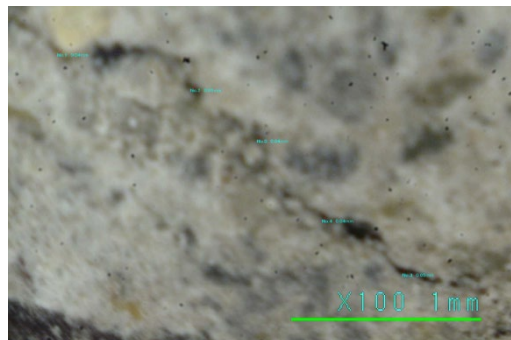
ひび割れ状況（端部上面：北側）
